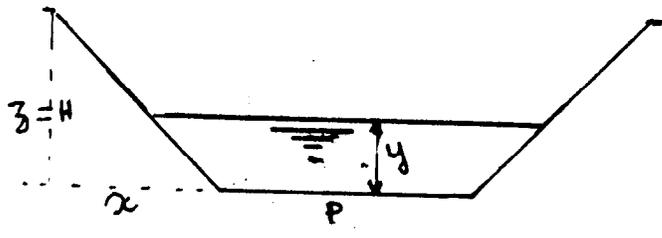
(b) Coupe transversale d'un canal trapézoïdale
